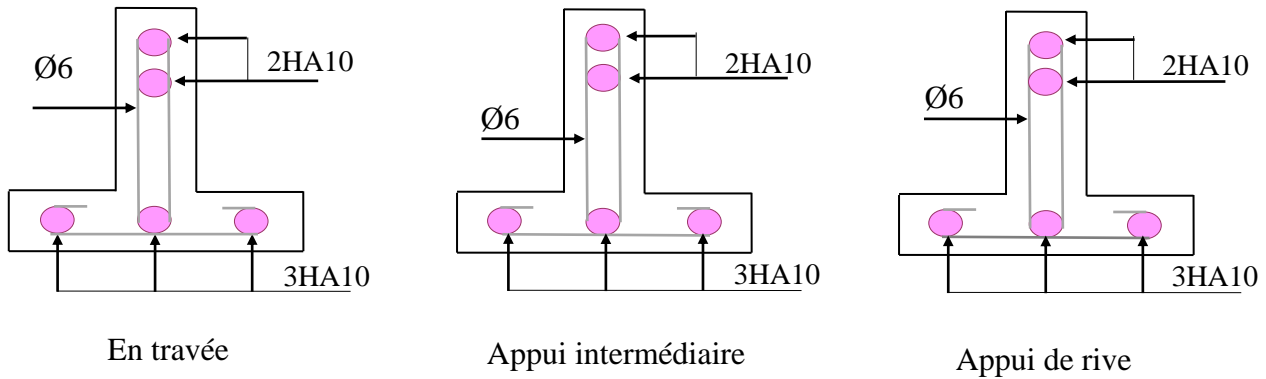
Schéma de Ferrailage des poutrelles plancher terrasse (Type1).
